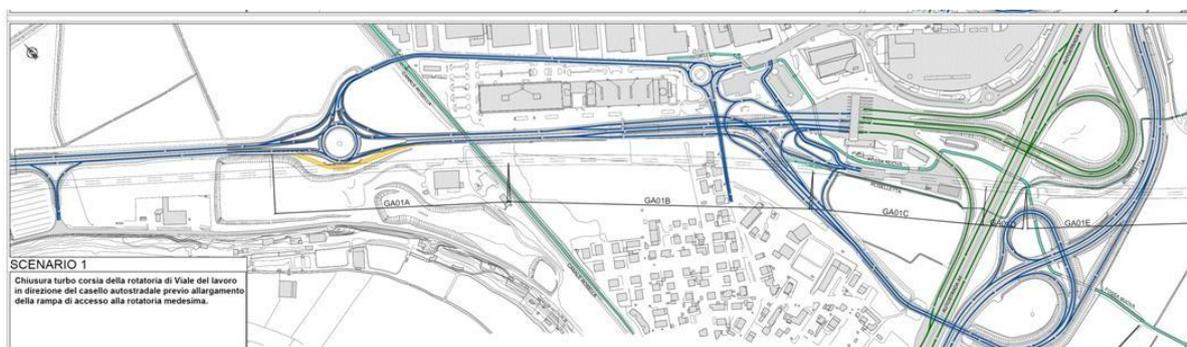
Assetto di rete dello Scenario di cantierizzazione #1
